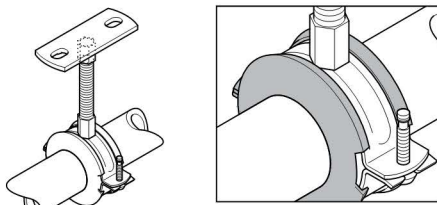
Rohrschelle mit Schalldämmeinlage ohne Einlegeschale
